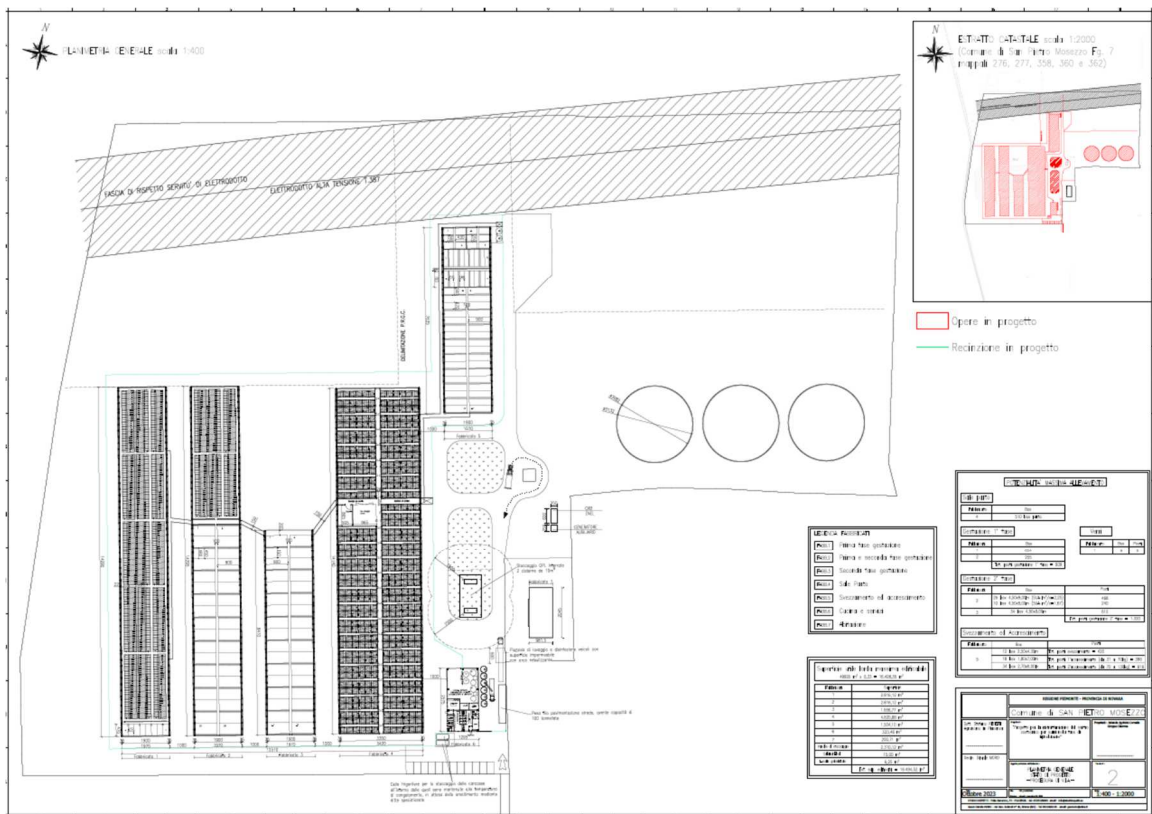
Planimetria generale stato di progetto (Tavola 2)
